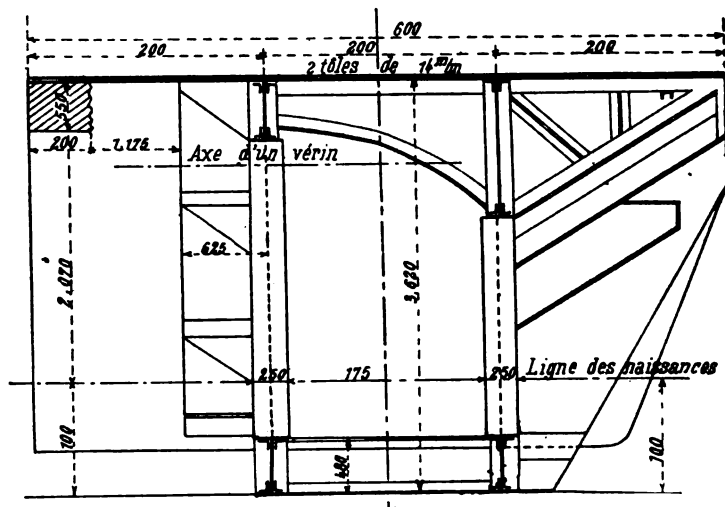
Coupe longitudinale du bouclier Lamarre.
